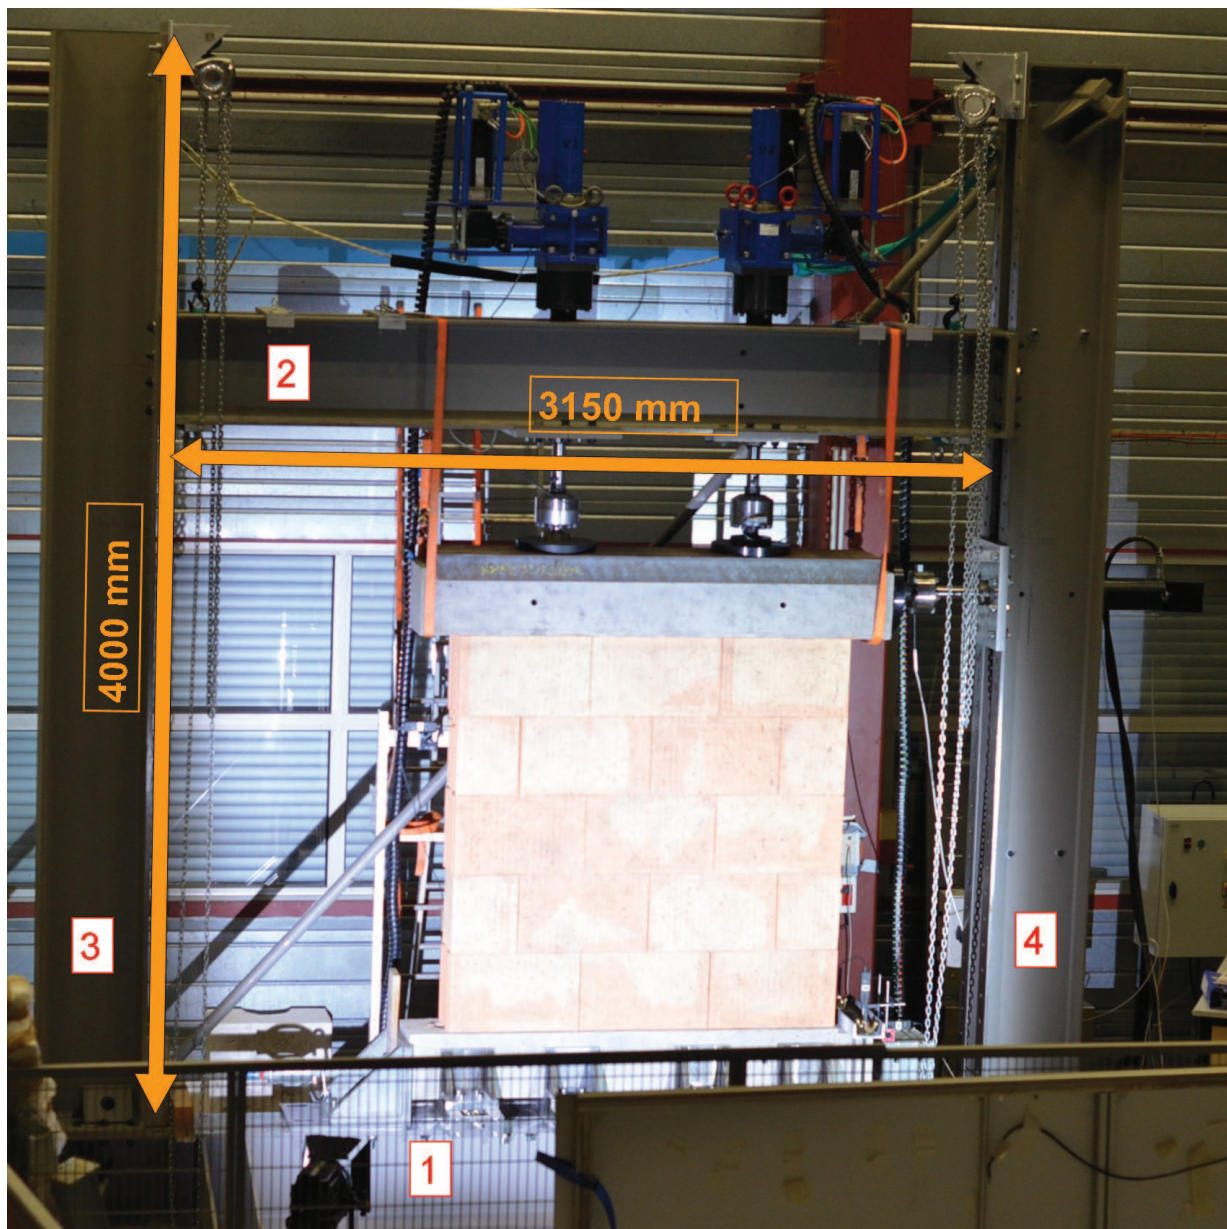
Portique de chargement du LOCIE. Dimensions globales et numérotation des poutres et poteaux.
